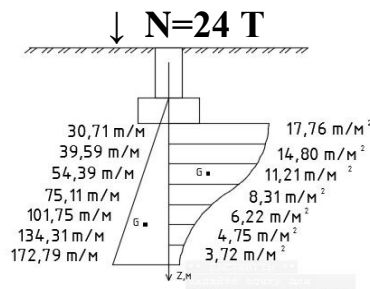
Расчетная схема крайнего фундамента.
